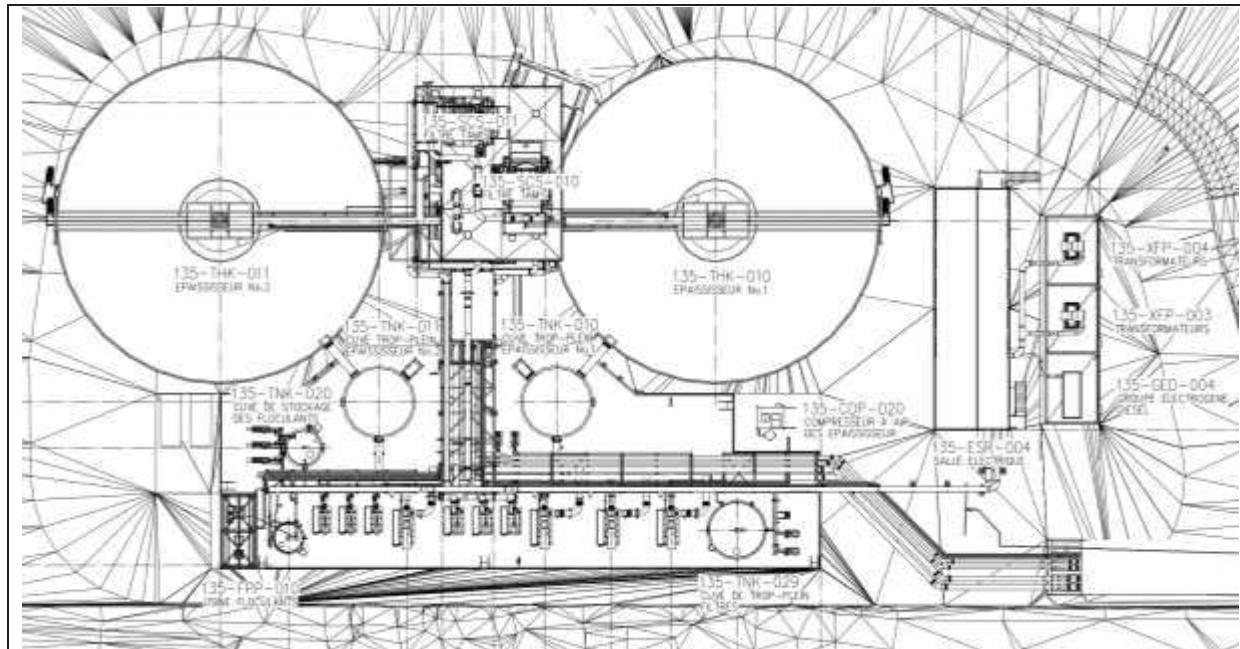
Plan d'arrangement 2D des épaisseurs près de DWP1 (réf : EXT-135-8400-SK-7001)
